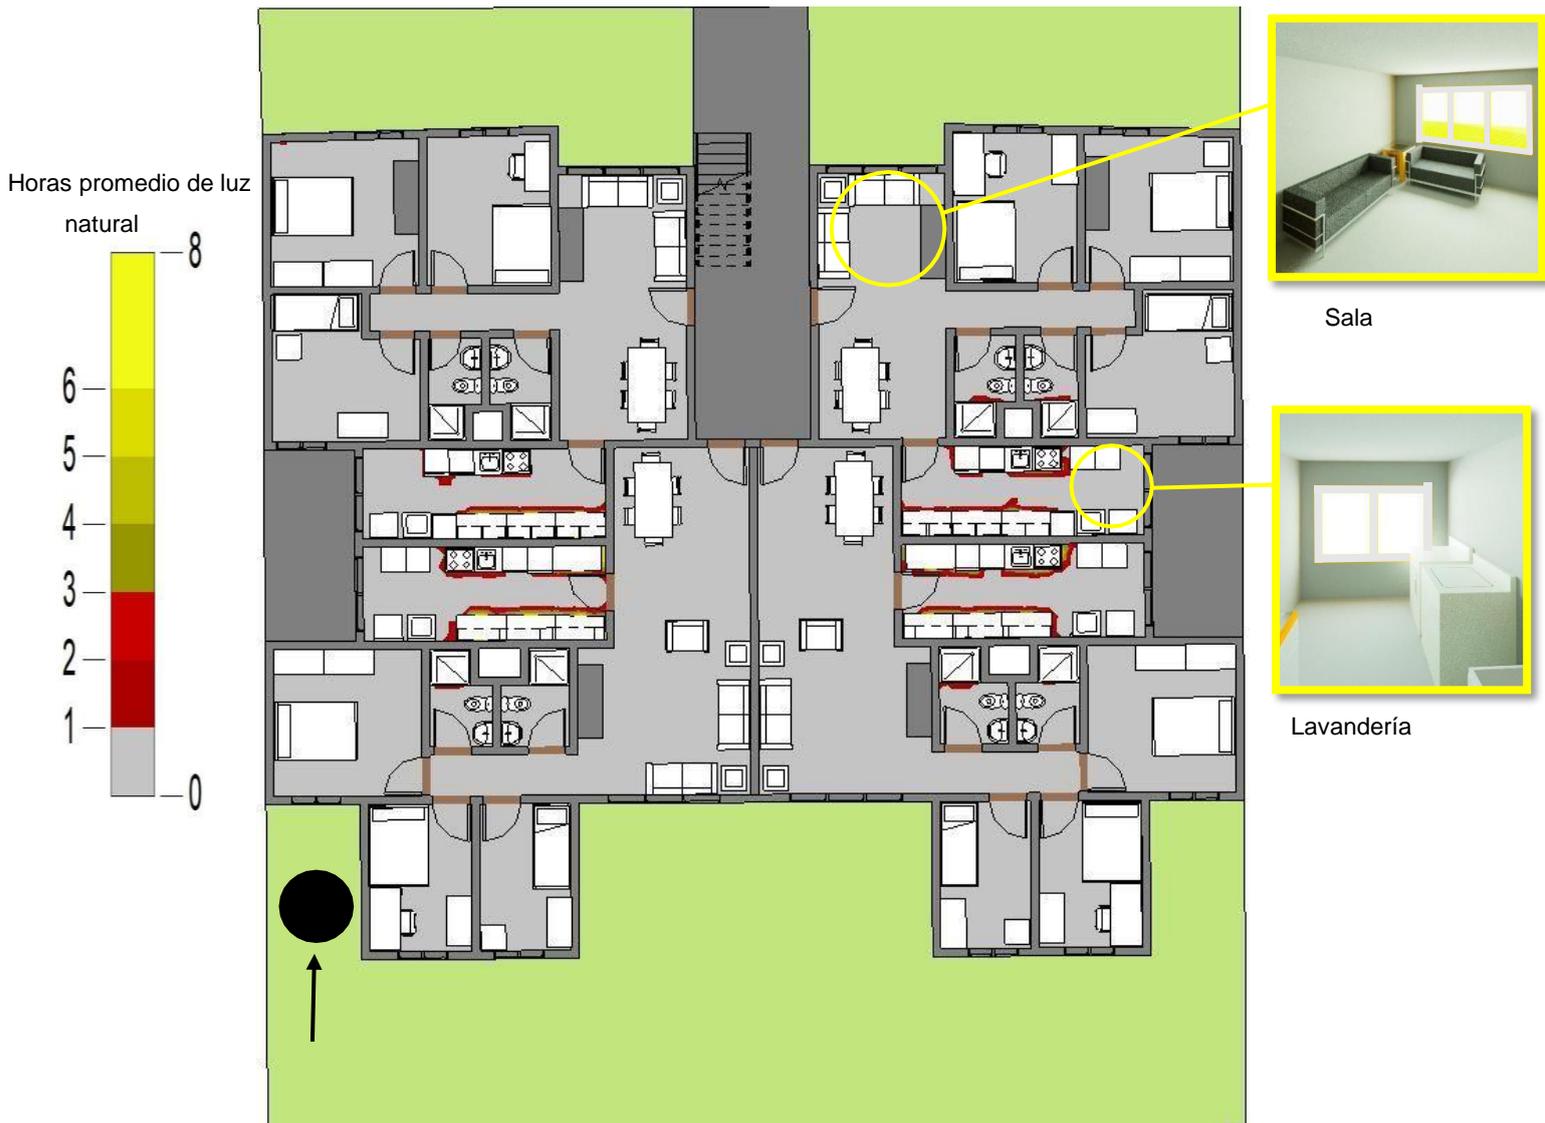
Planta típica-Fachada sur-este-Nivel 1 (ver lámina L-03).
